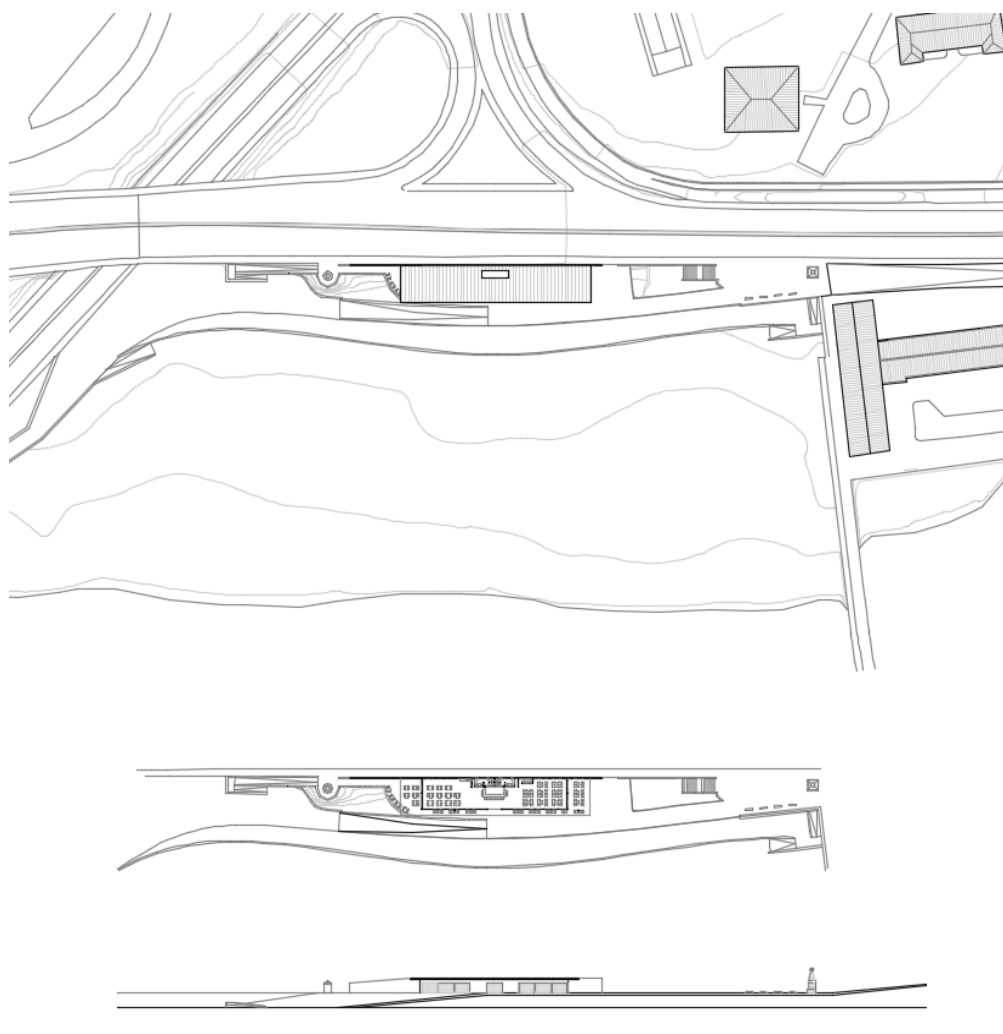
Planta e alçado em que se pode ver o restaurante proposto e o seu muro de protecção do vento Norte e do ruído da estrada, e da rampa que eleva os utilizadores do nível da praia de Paço d'Arcos.
